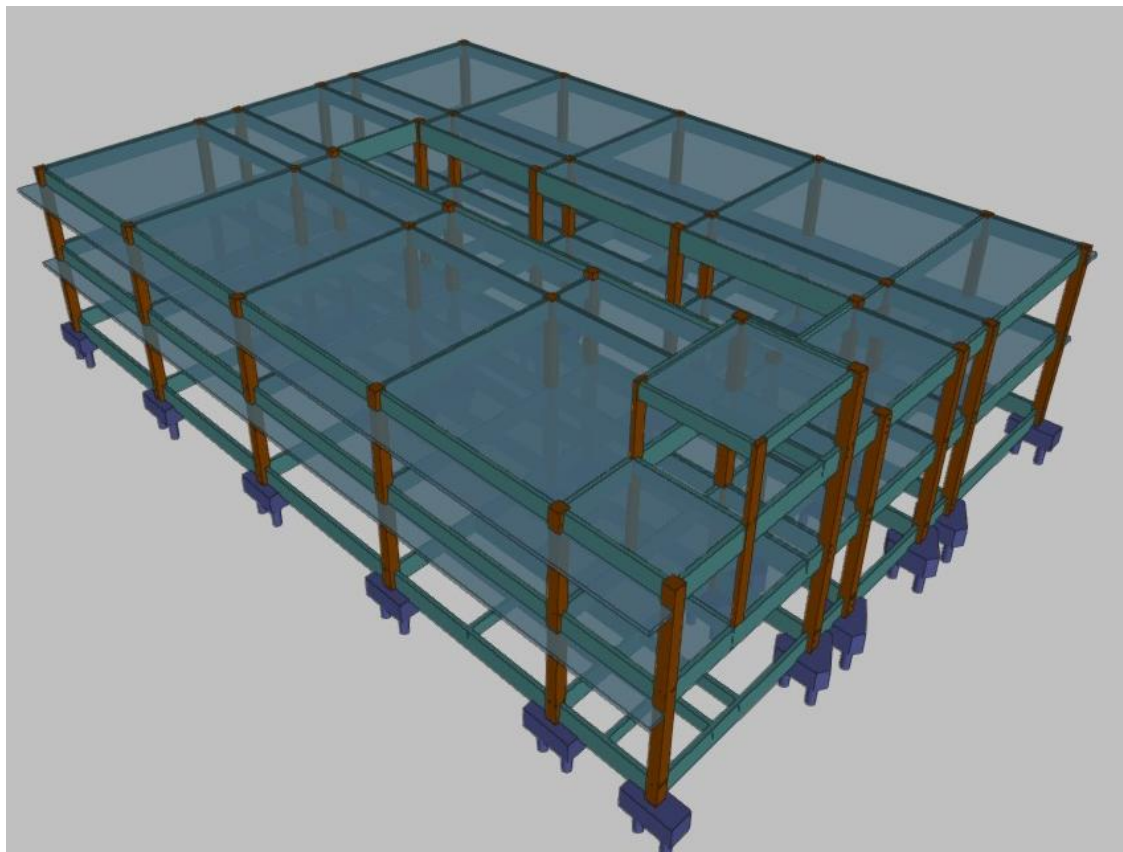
Prédio Escolar Parte 1– Modelo estrutural 3D vista 1
